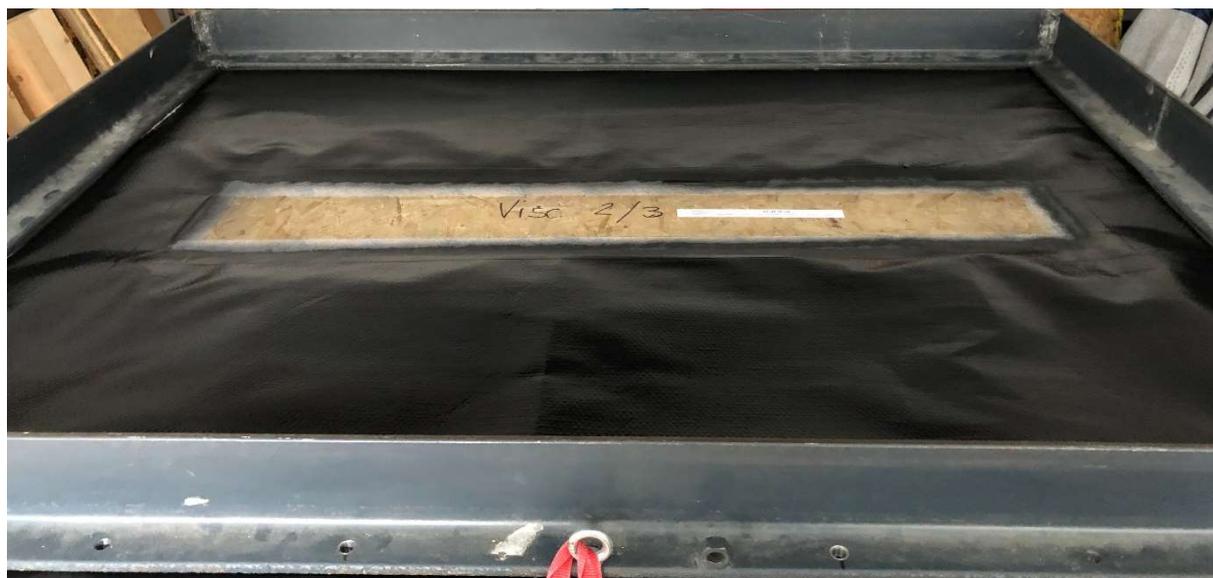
Contrôle de l'étanchéité d'un joint avec un panneau en bois.
